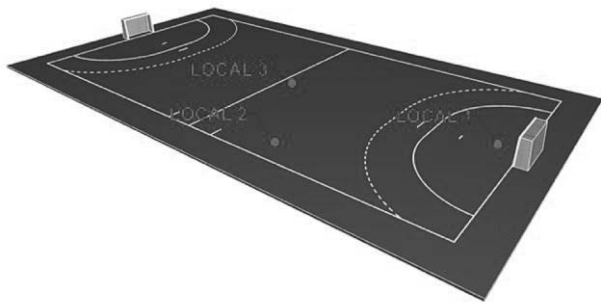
Identificação dos locais de ensaio no pavimento do pavilhão.
